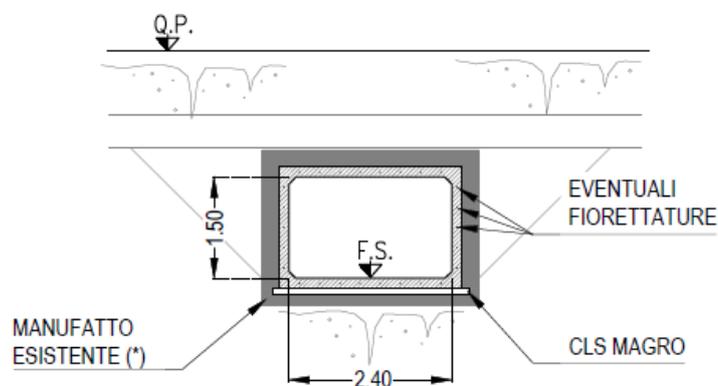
Sezione di progetto prolungamento scolo Ciron
